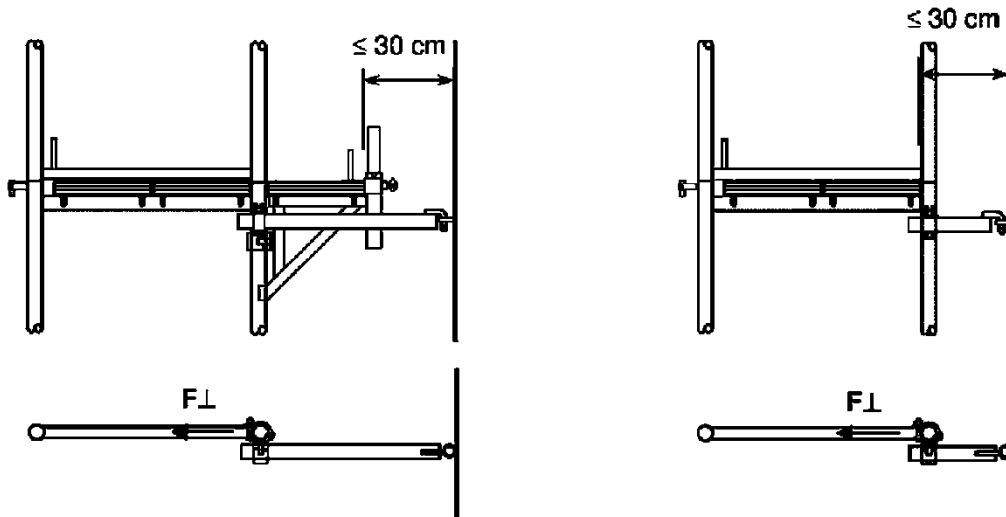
Höhenlage der Gerüsthalter bei Anschluss im „Knoten“.
